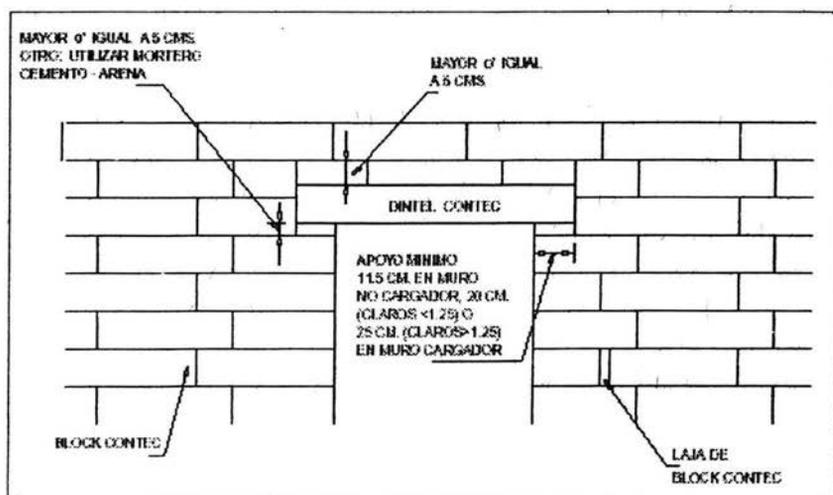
En la figura se ilustra un ejemplo de colocación de dinteles de concreto celular reforzado, se muestran las longitudes mínimas de apoyo requeridas.
